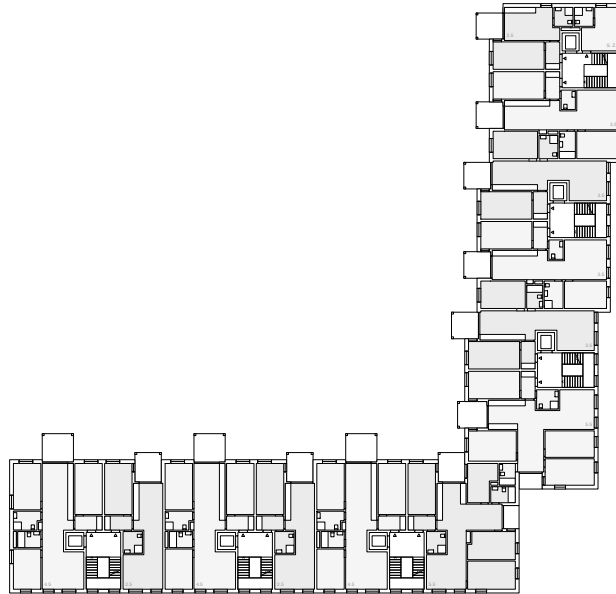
Waldarena: 3. und 4. Obergeschoss
